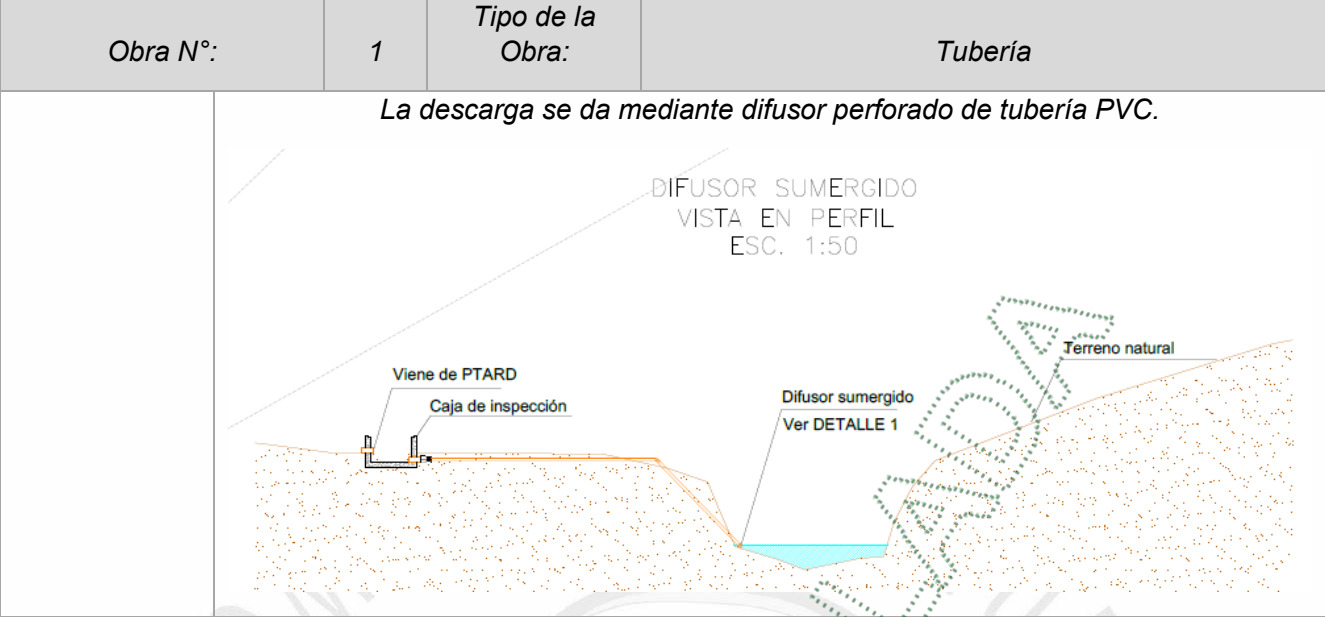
Tipo de la Obra:	Estructura de Descarga
